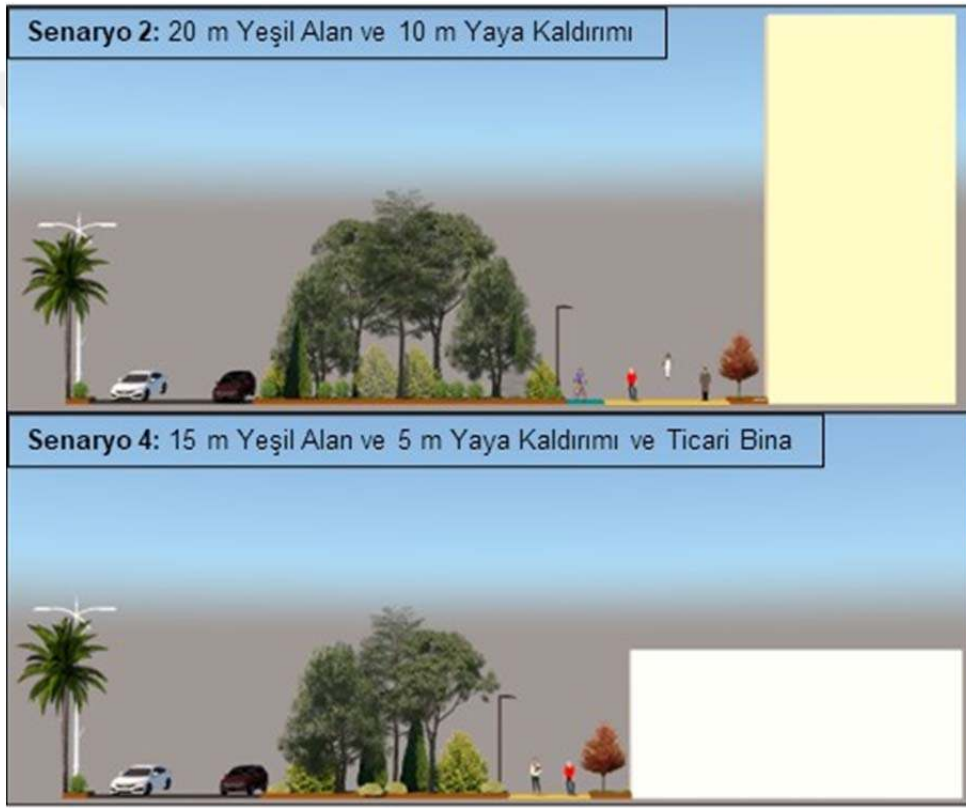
Yol ve alıcı arasında bırakılan yeşil alan örnekleri, plan görünüşleri (FHWA, 2019)
